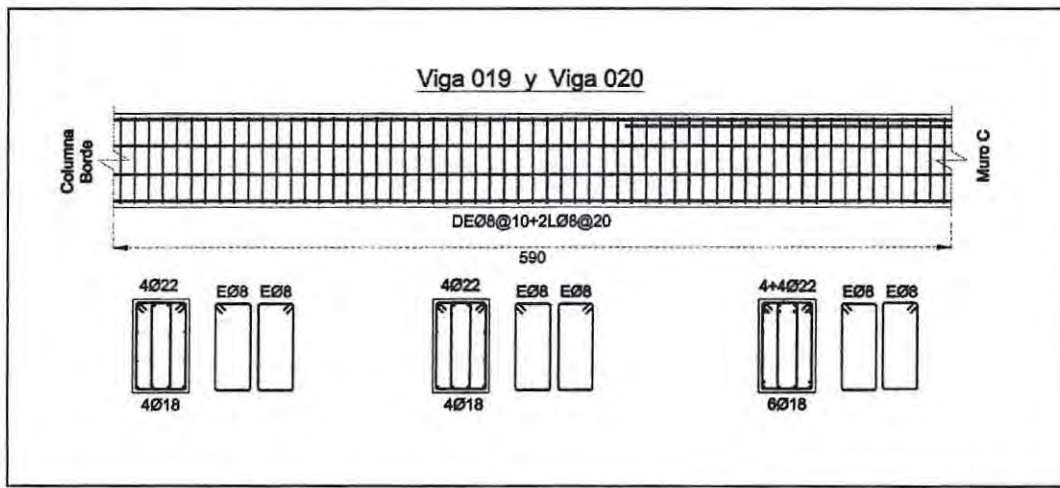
Distribución armadura de corte en vigas Eje 2, estructura mixta.
